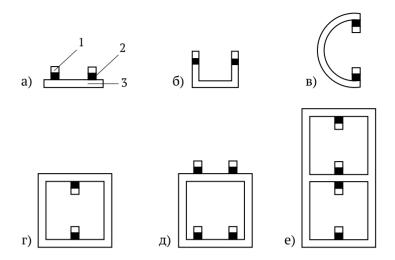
Схемы размешения поперечных планок в путевой структуре СТС (варианты): а, б, в, г – одноярусная СТС: д, е – двухъярусная СТС; 1 – рельс; 2 – электроизолятор; 3 – поперечная планка
